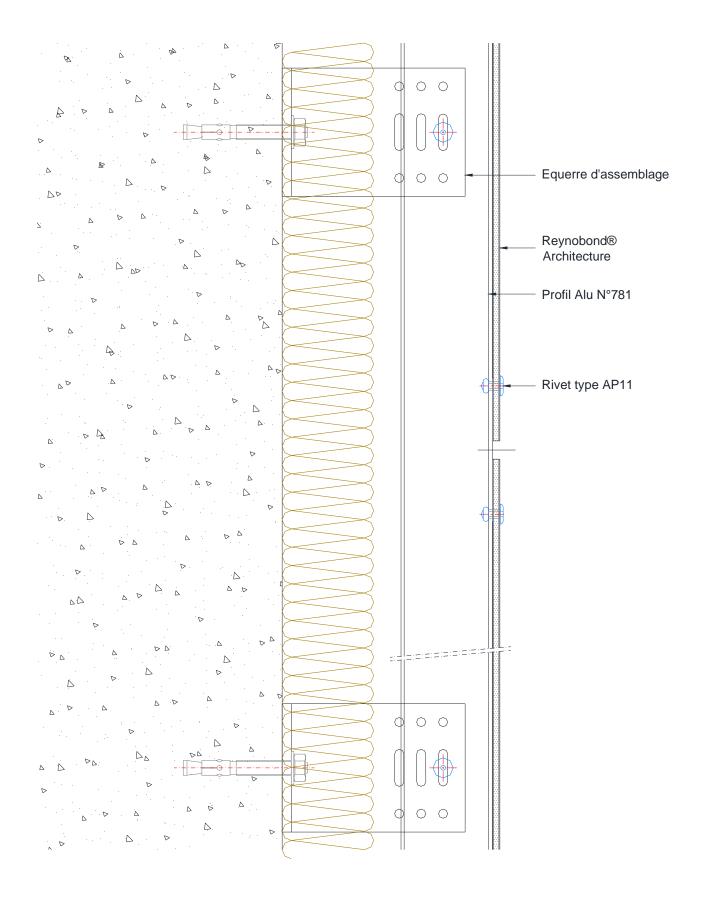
Joint horizontal - Coupe verticale – Système riveté RV 50 2c
